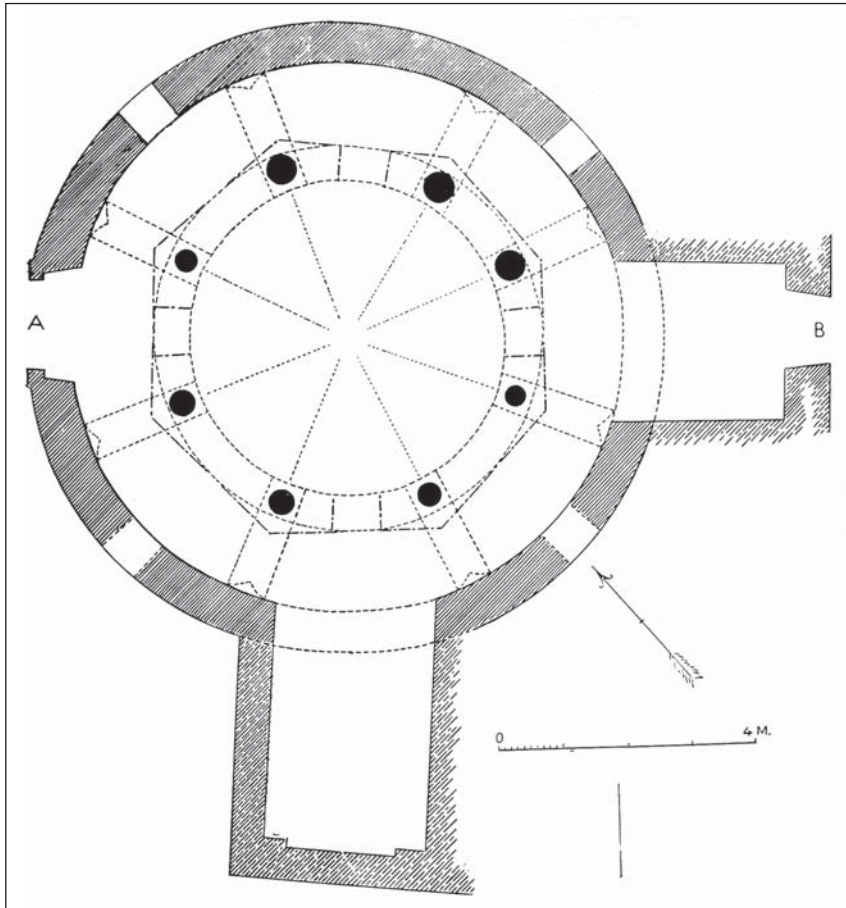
Santa Severina, battistero, planimetria (da ORSI 1929).
